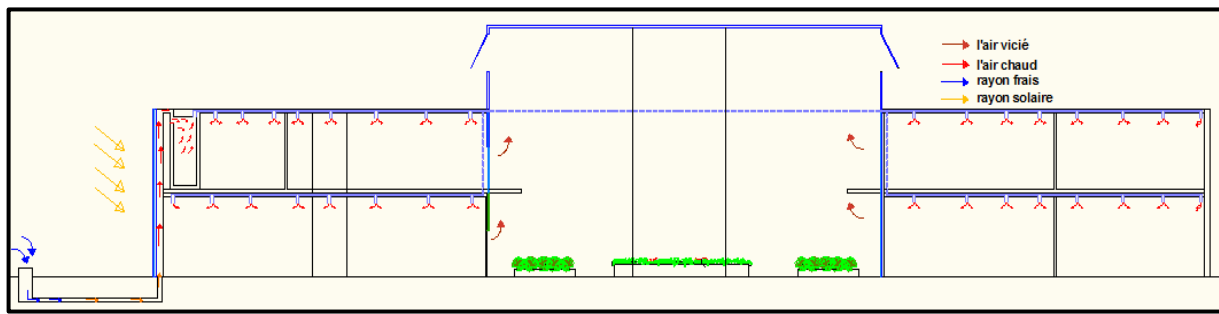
système puits canadien- façade double peau (Source : auteurs)
